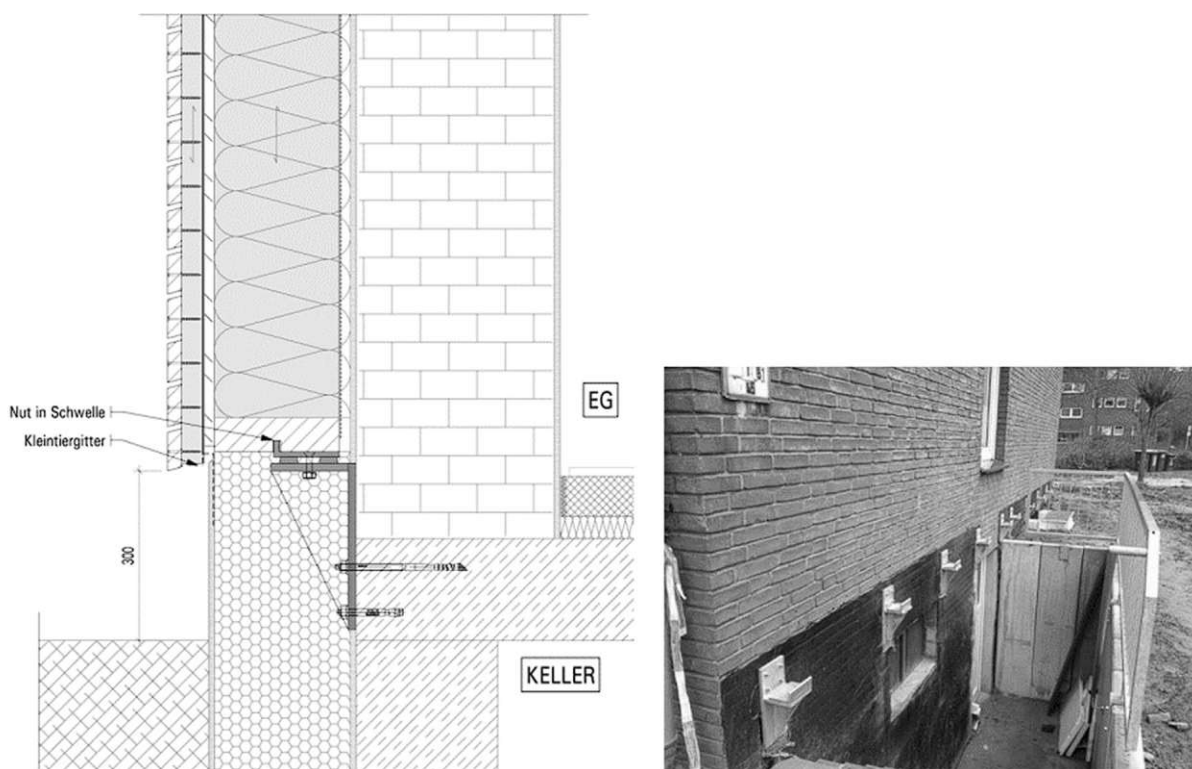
Detailanschluss Fertigelemente an Bestandswand
